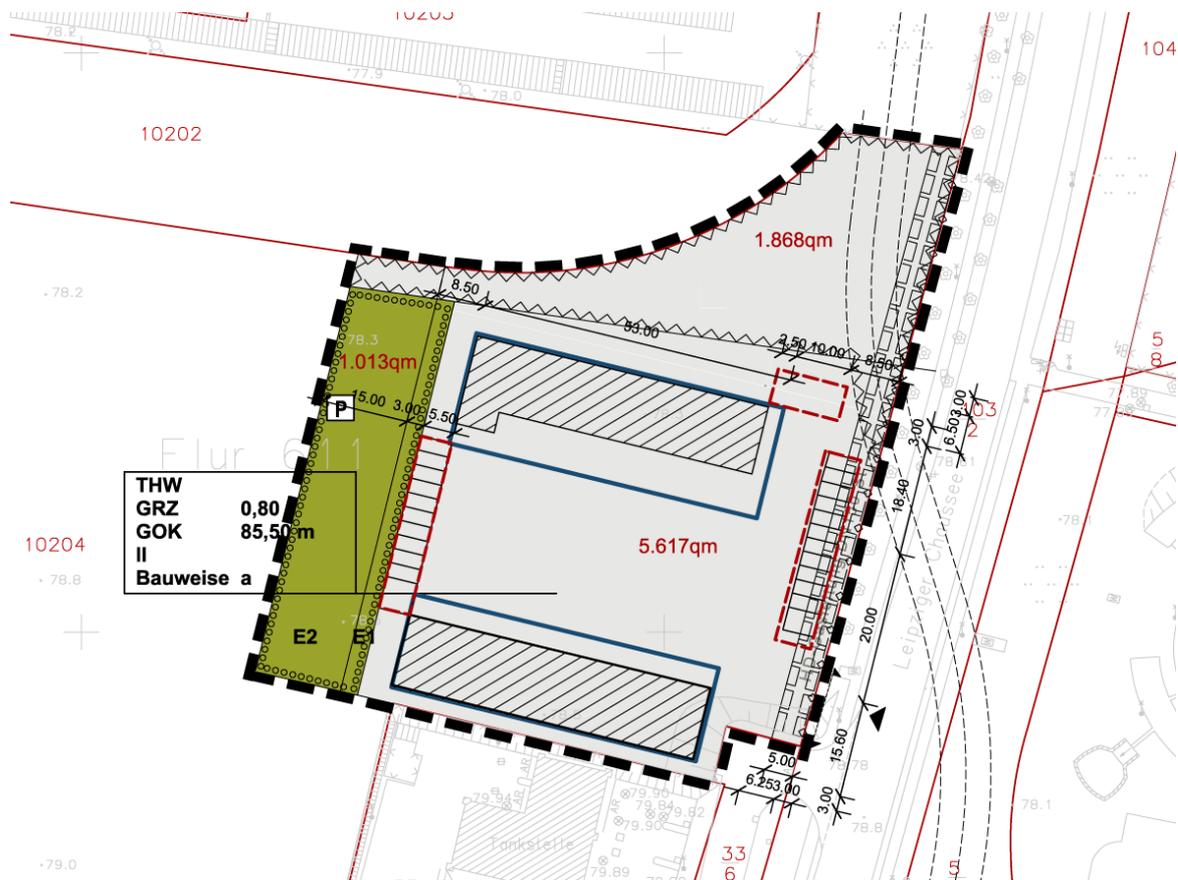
vorhabenbez. B-Plan Nr. 428-5.1 „Neubau Geschäftsstelle/Ortsverband THW“ (Entwurfsstand: 08.2013, Ausschnitt)
